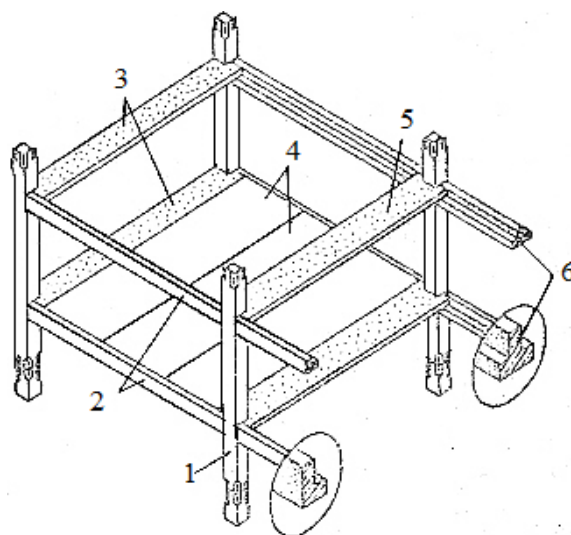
Конструктивные элементы сборного железобетонного каркаса гражданского здания
